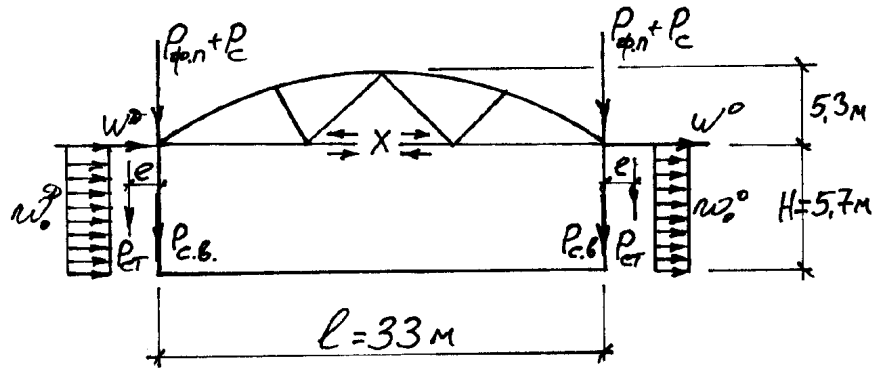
Схема навантажень на поперечну раму будівлі
